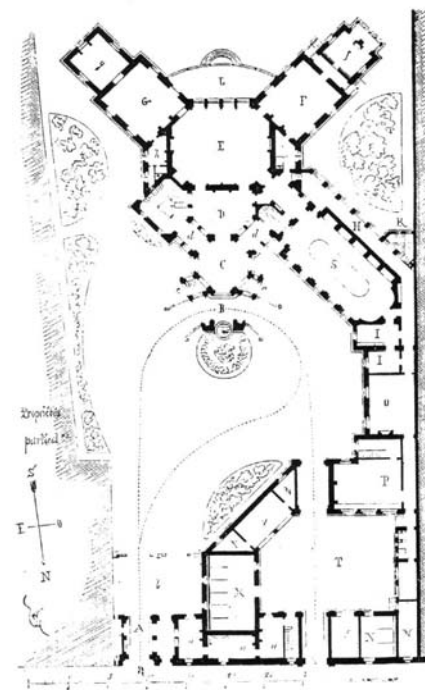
Viollet-le-Duc, Hotel Entretien, planta térreo.
